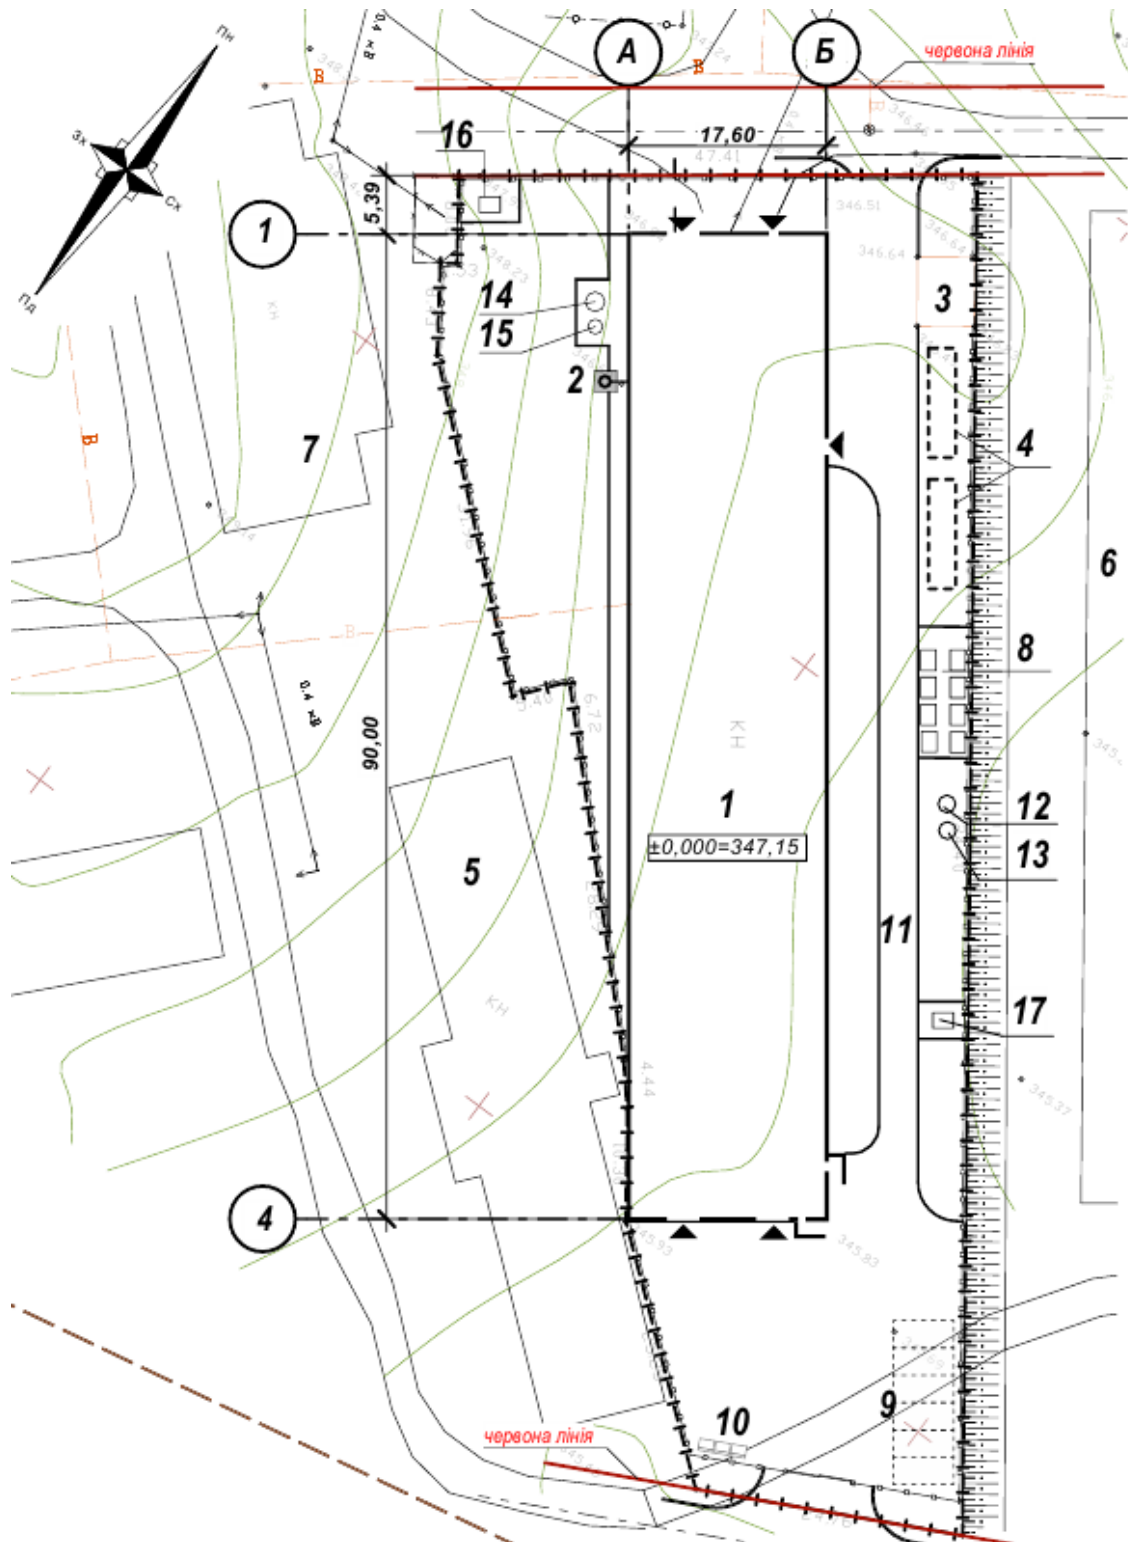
План розташування існуючих будівель та інженерних мереж
